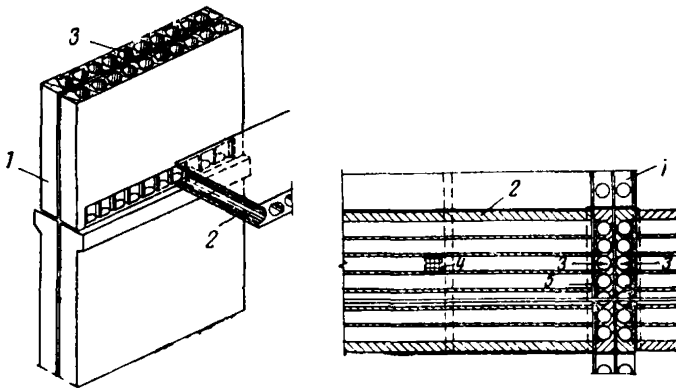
Устройство каналов в пустотах бетонного настила перекрытий
